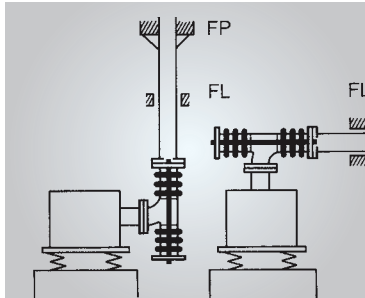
Eckentlasteter Kompensator an schwingendem Aggregat
